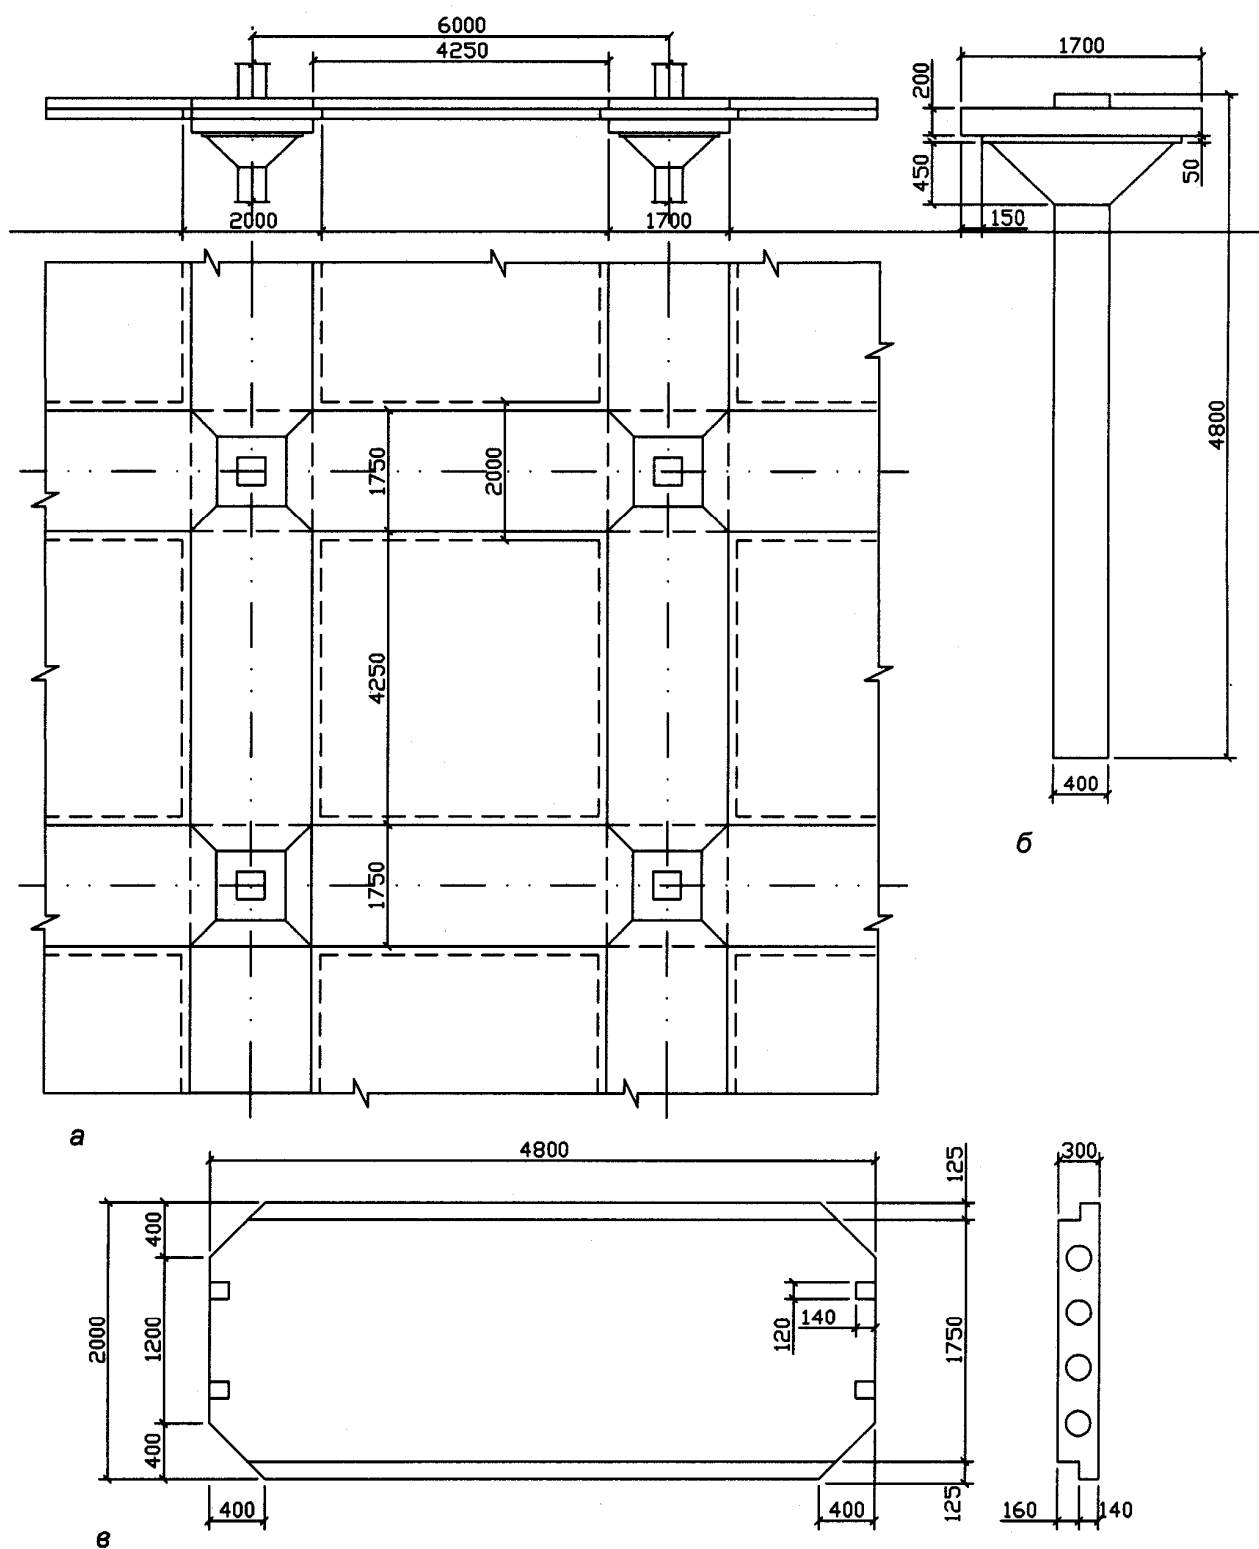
Схема збірного безбалочного залізобетонного перекриття із колонами з капітеллю:
